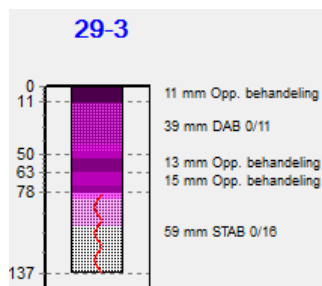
Constructieopbouw reconstructievak 5 tot Wilgenlaan
